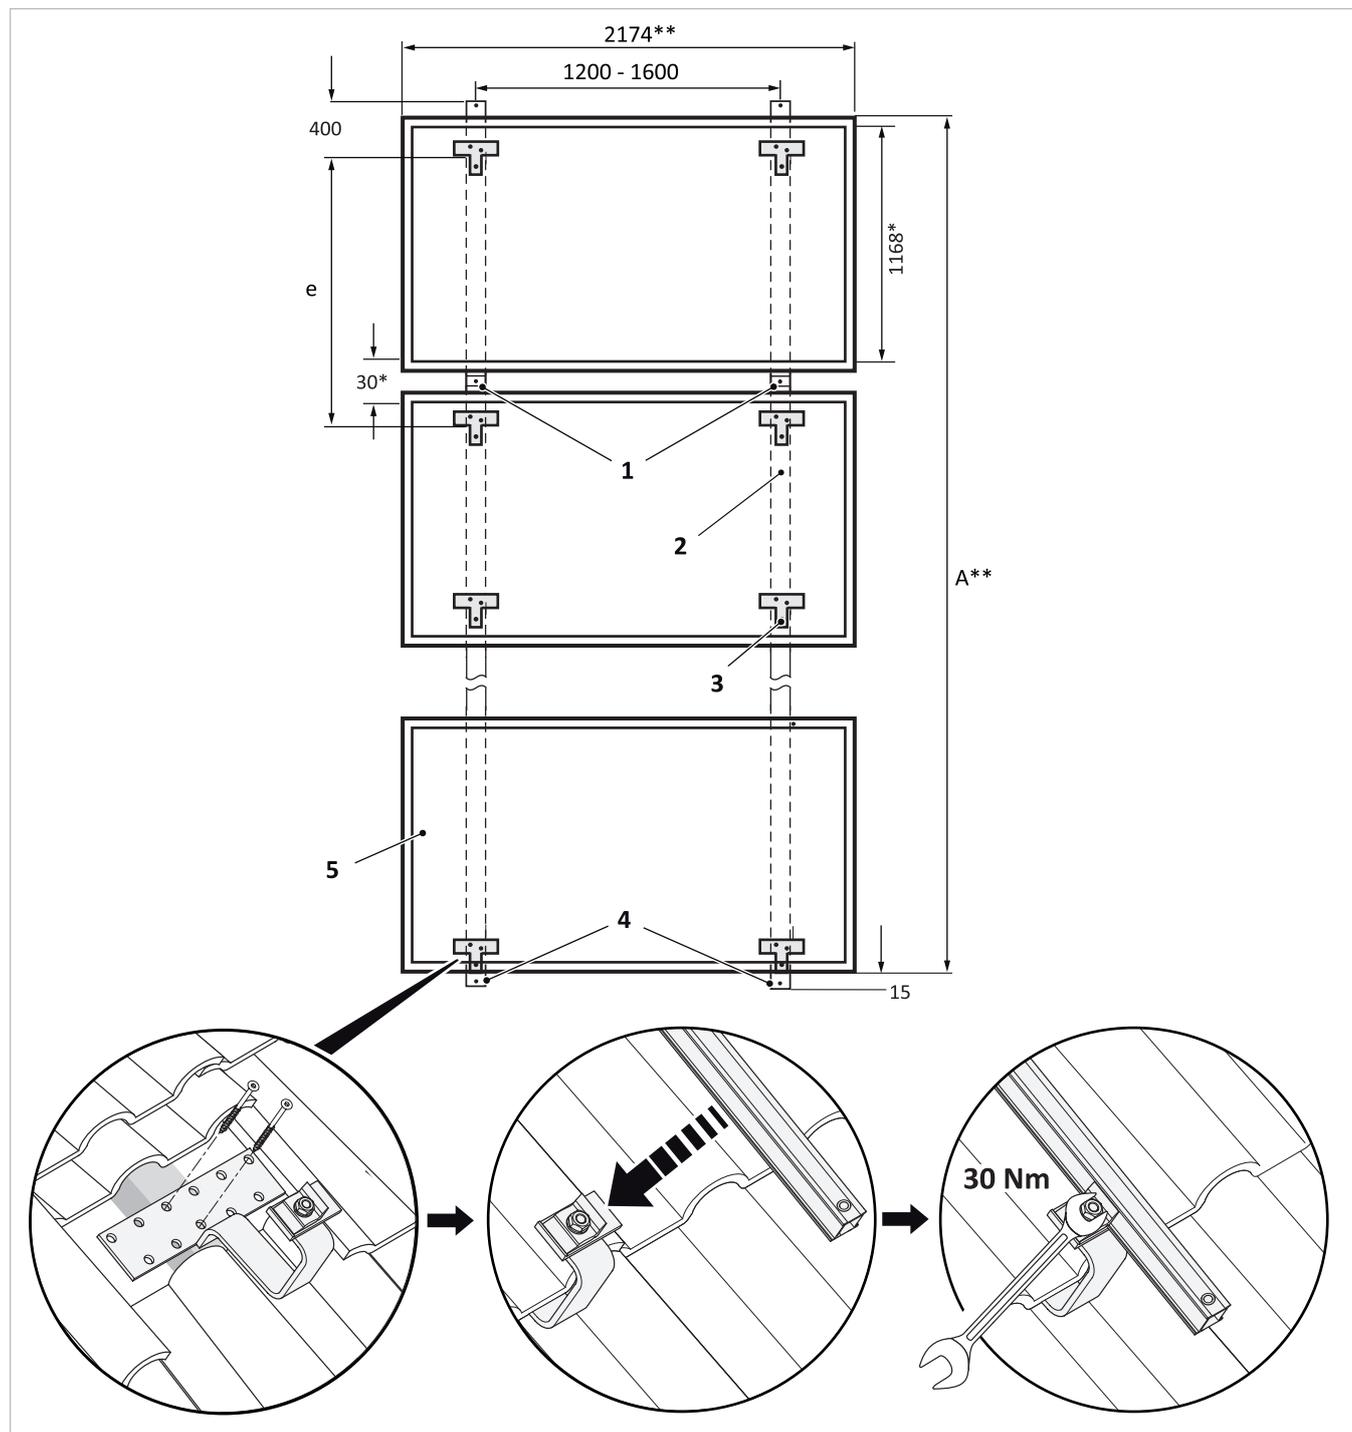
montaggio sovrapposto dei supporti per il tetto e delle guide di montaggio. La tipologia del supporto per il tetto varia a seconda del tipo di copertura. Attenersi alle istruzioni di montaggio fornite con il supporto per il tetto.
